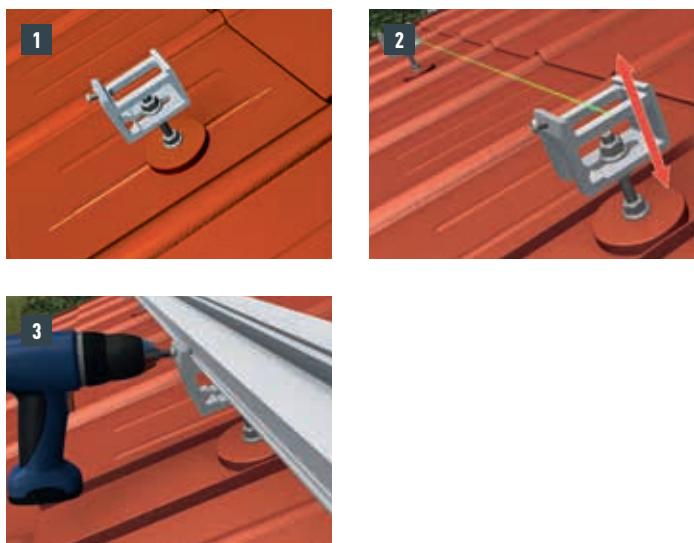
• Fissaggio del sistema di montaggio per pannelli solari
